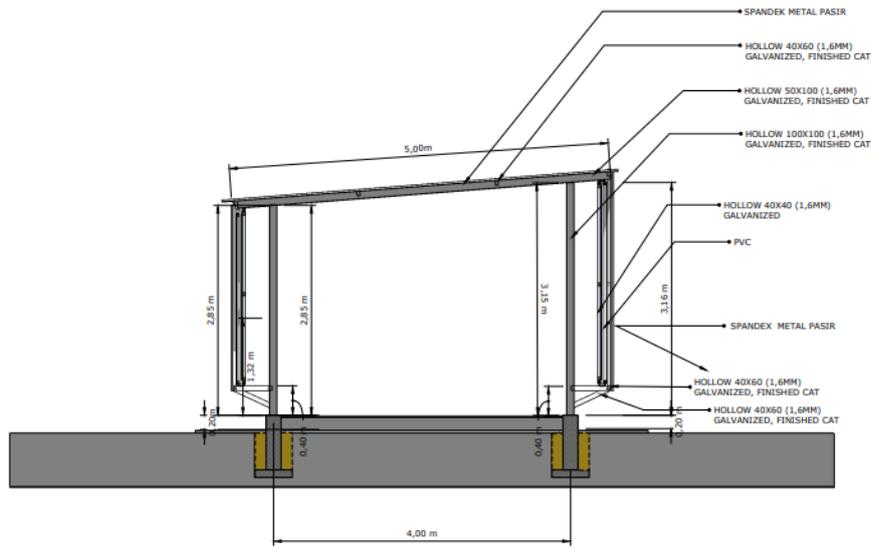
Tampak samping Kanan b. Tampak Depan
